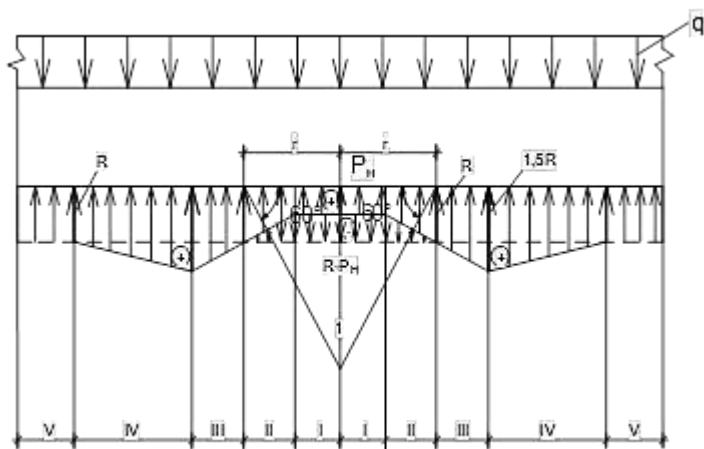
Епюра рівноваги діючих та реактивних сил під підшовою фундаментів: I – конус замочування просадного ґрунту; r – радіус конуса замочування просадного ґрунту; I – зона просідання; II – зона осадки; III – зона обтиснення ґрунту основи; IV – зона стабілізації; V – зона рівноваги всіх сил
